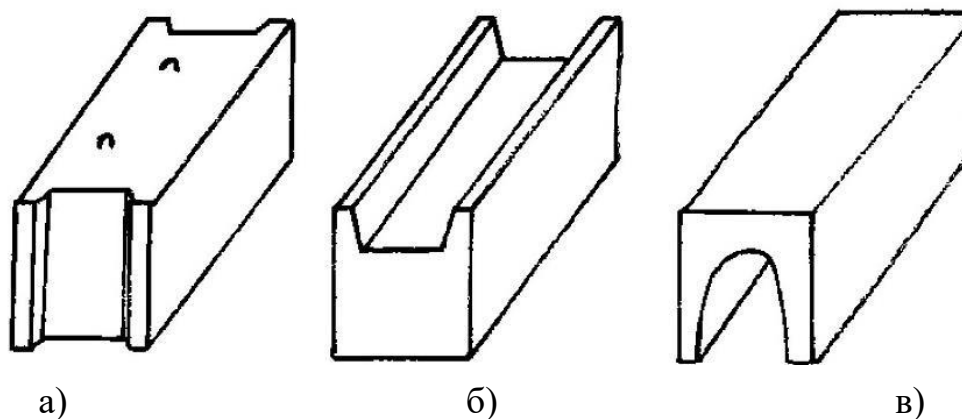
Збірні фундаментні стінові блоки: а – суцільні (ФБС); б – суцільні блоки з вирізом (ФБВ); в – пустотілі (ФБП).
